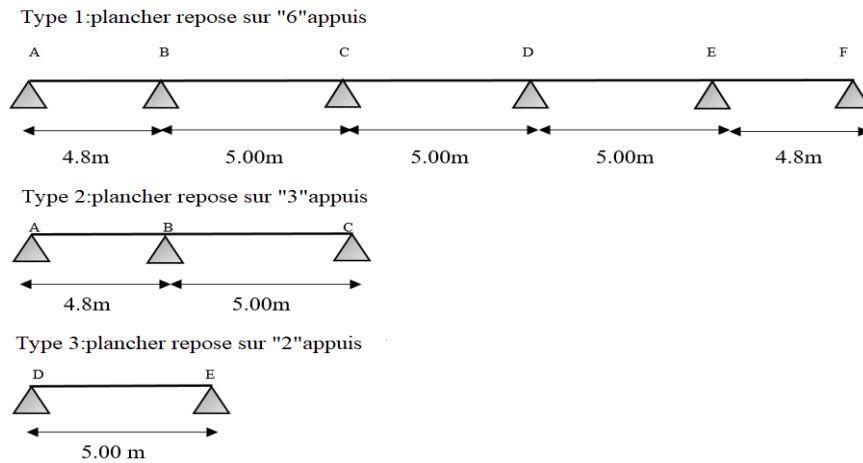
a trois types de poutrelles dans les planchers d'étages courant et terrasse inaccessible
